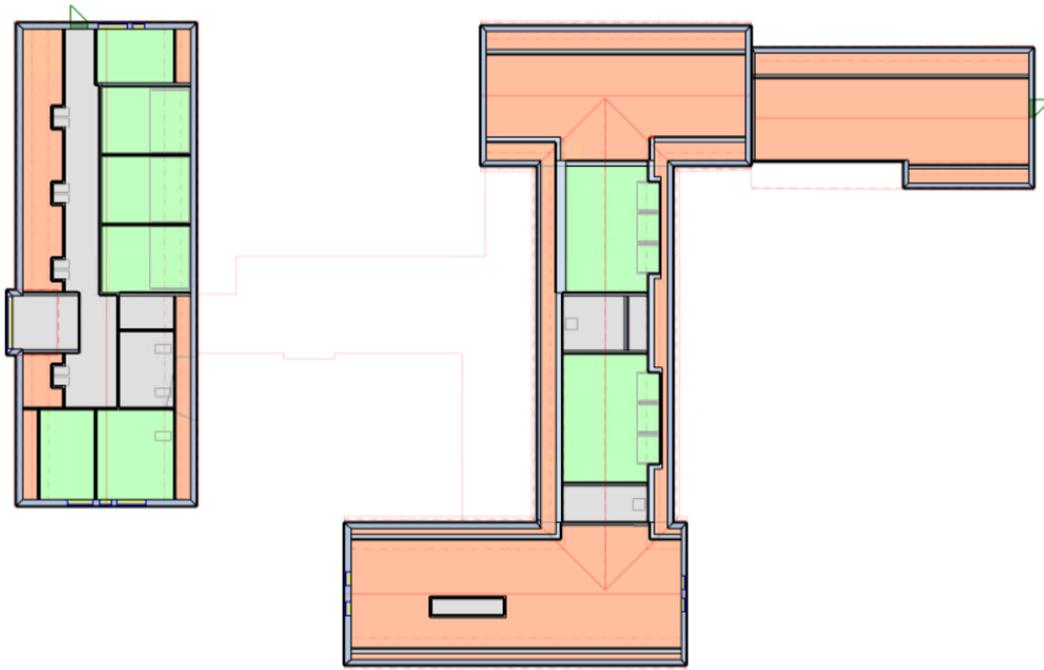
Grundriss Obergeschoss, zониert
